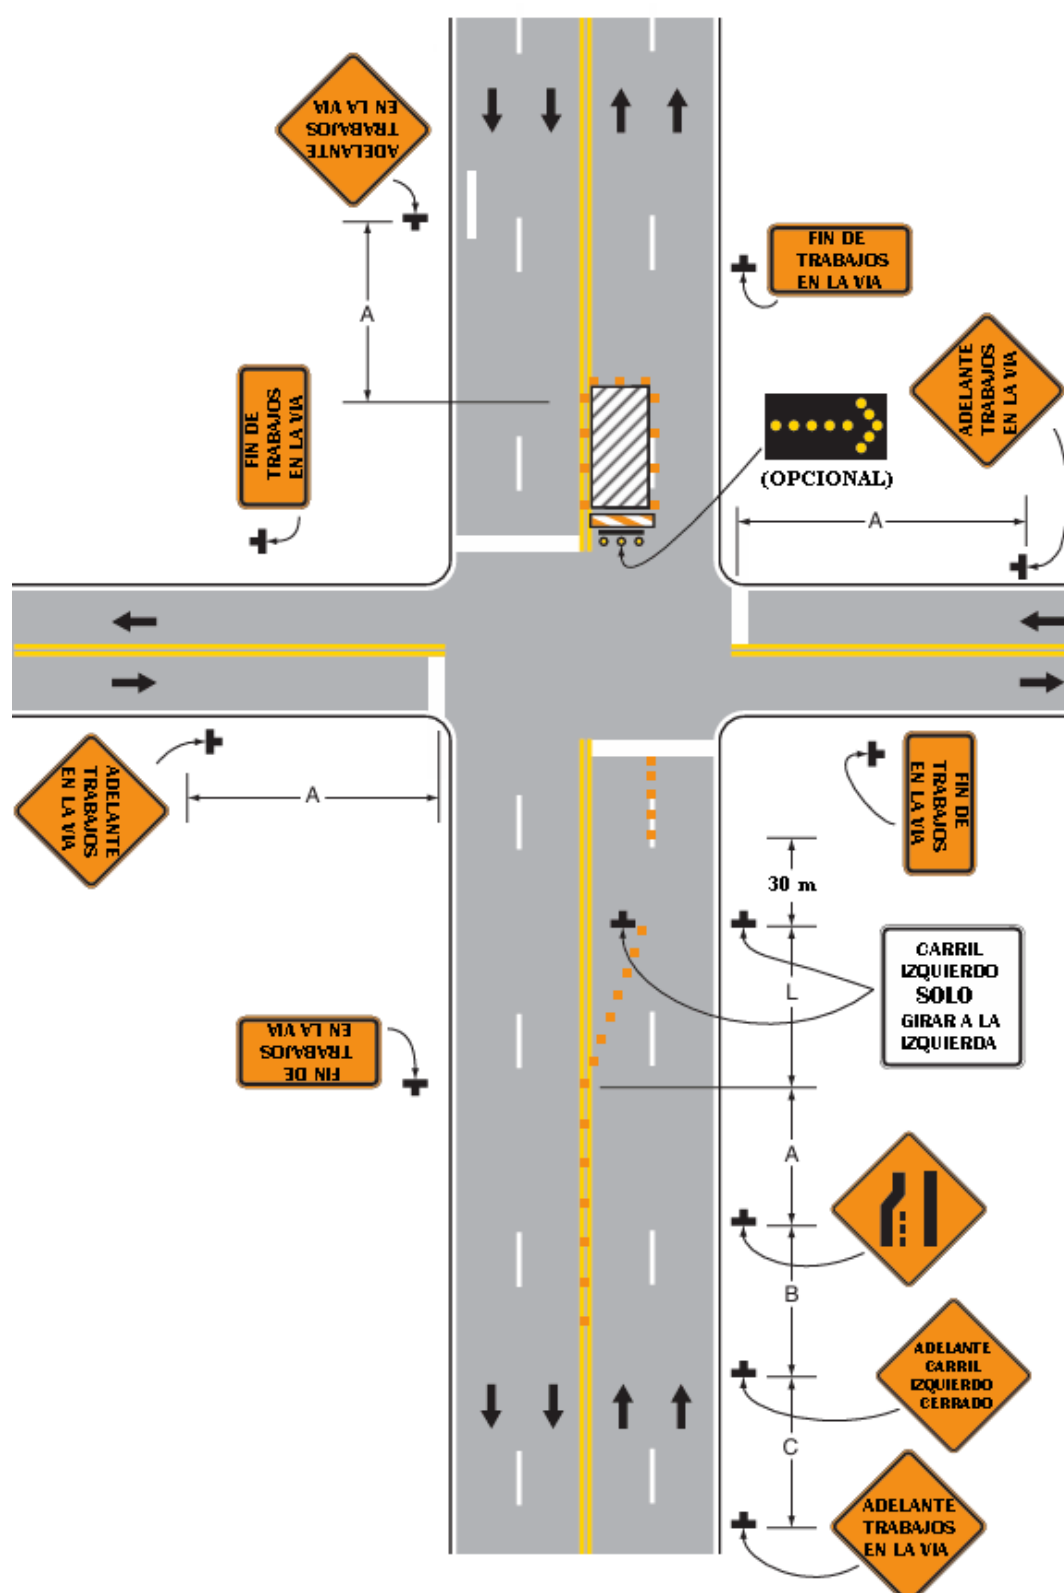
MTT para cierre de carril izquierdo al otro lado de una intersección.
